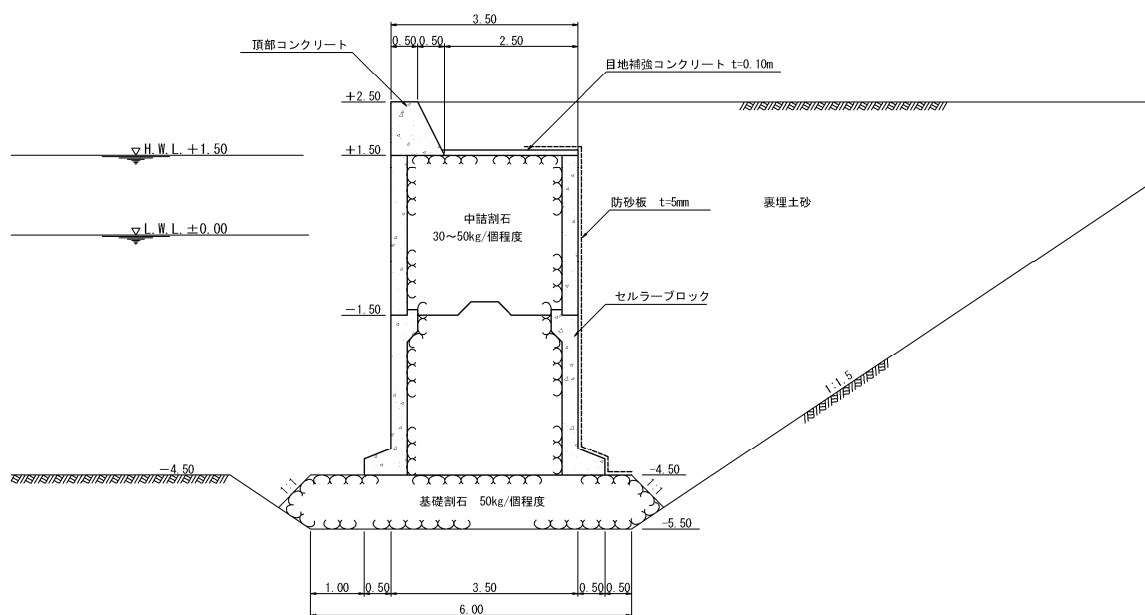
122 No. 3 居切導水路A岸壁の標準断面図（被災前）
